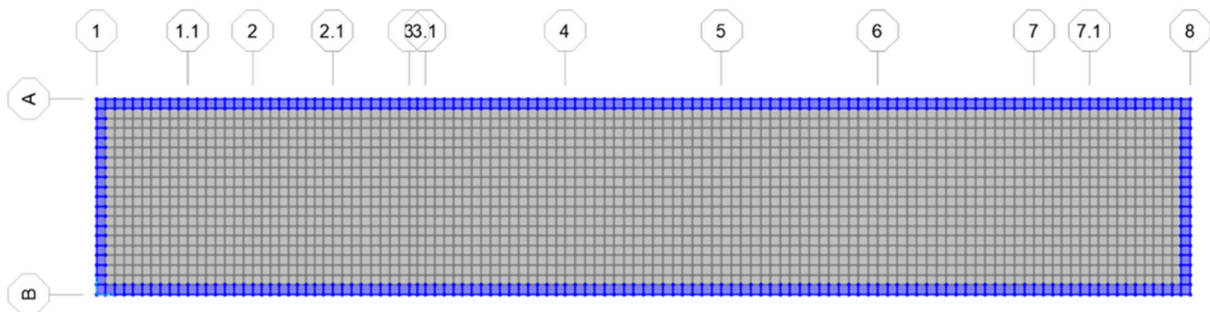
Pianta del modello di analisi della platea di fondazione – numerazione elementi shell
